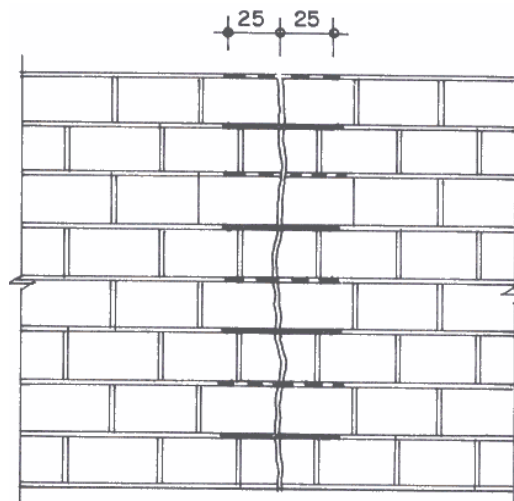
Recuperação de fissuras em alvenaria aparente, com o emprego de armaduras defasadas.
